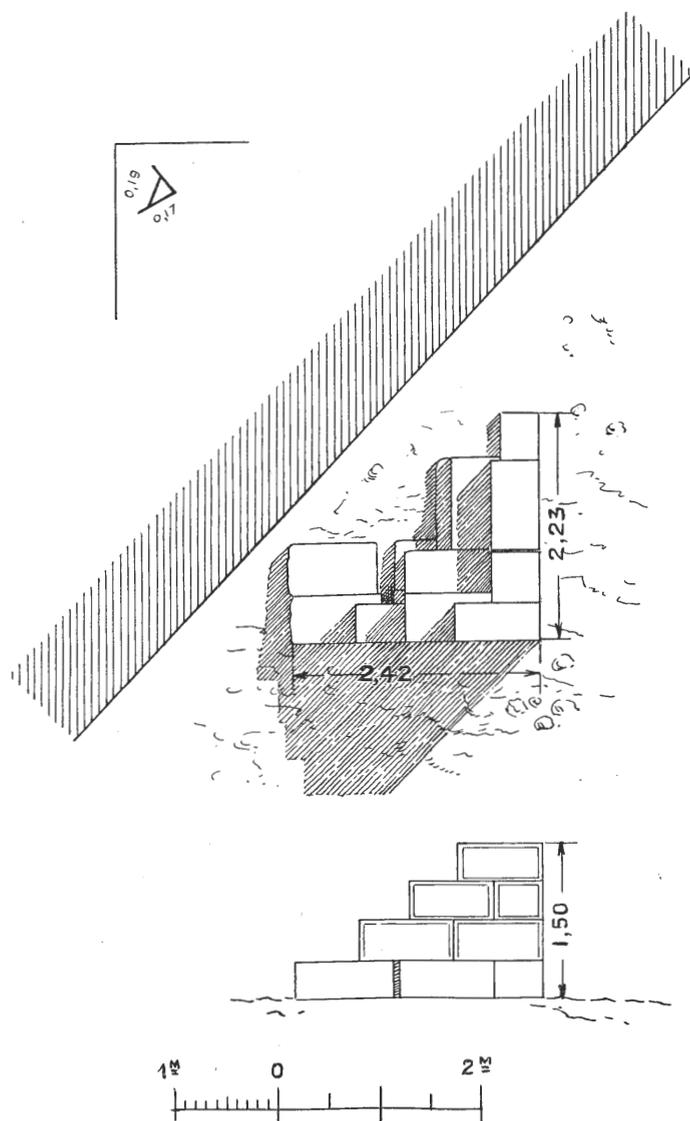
Trésor C. Plan et élévation (état actuel).
